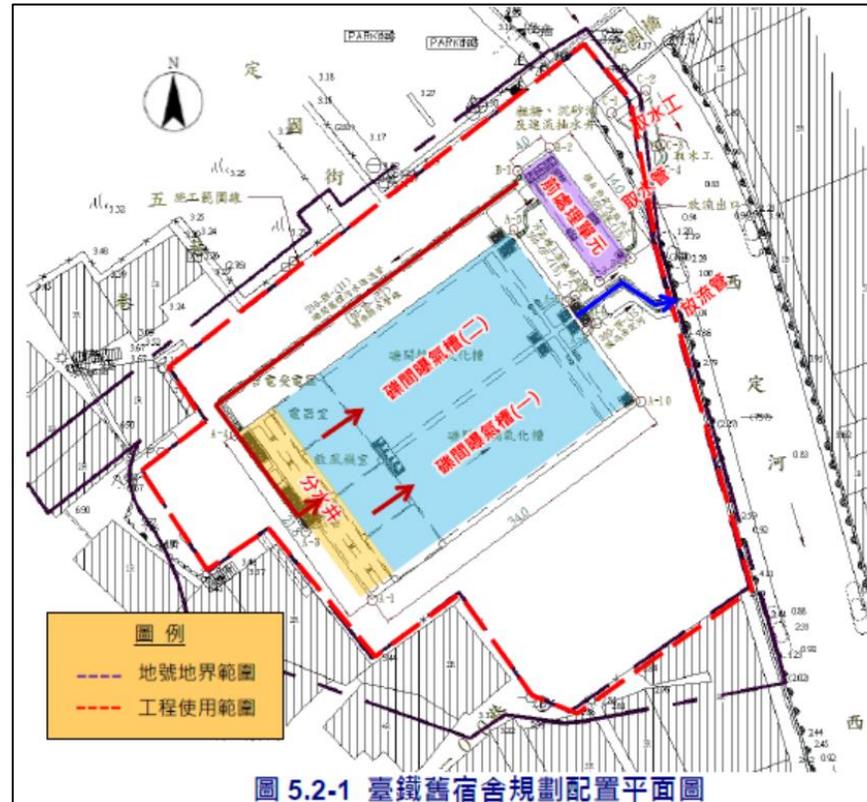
臺鐵舊宿舍規劃配置平面圖
